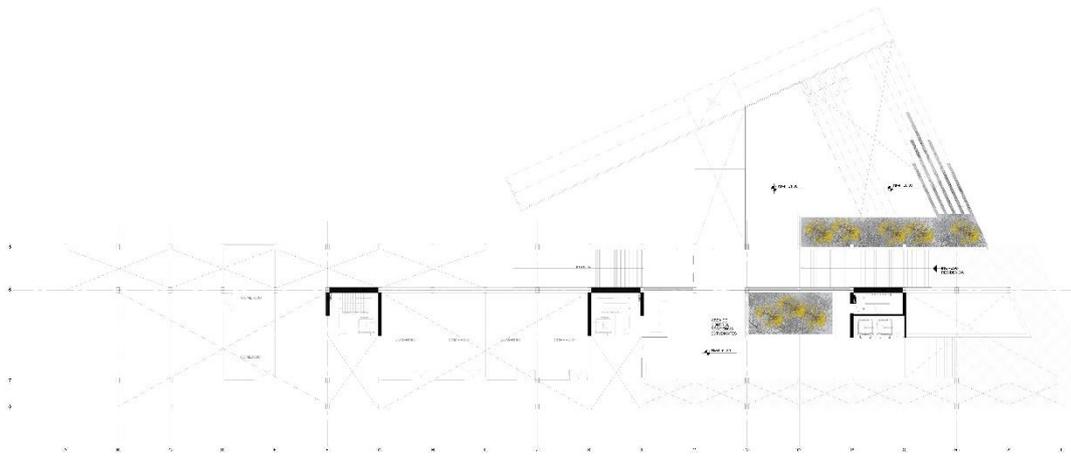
Planta +1.80. Control de ingreso al proyecto. Elaboración propia.
